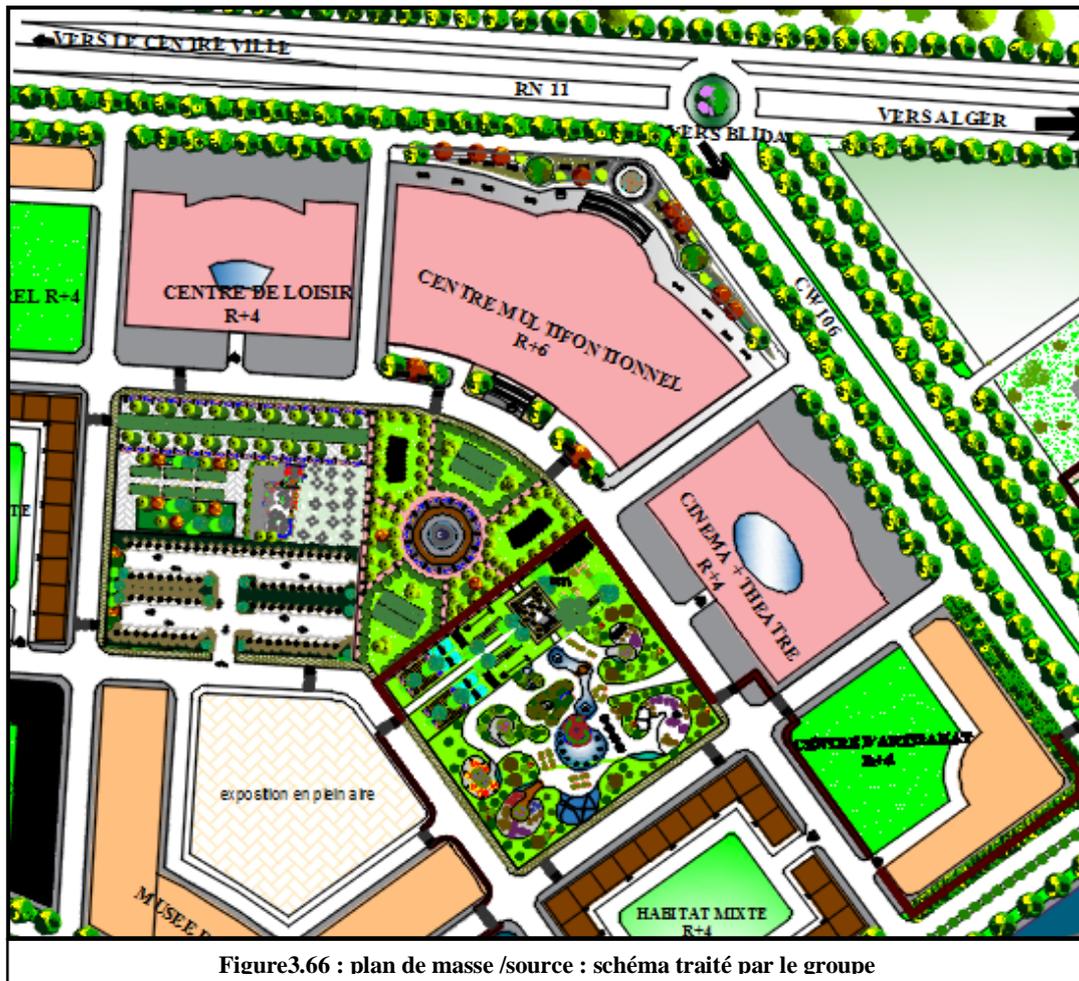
plan de masse /source : schéma traité par le groupe
